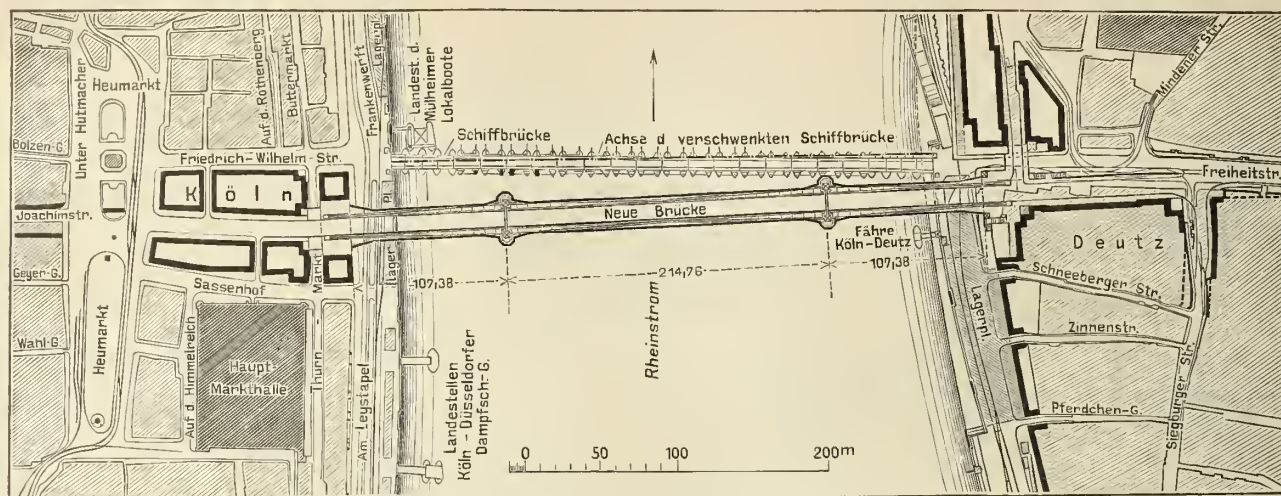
Lageplan mit dem Entwurf „Alaaf Colonia“.
